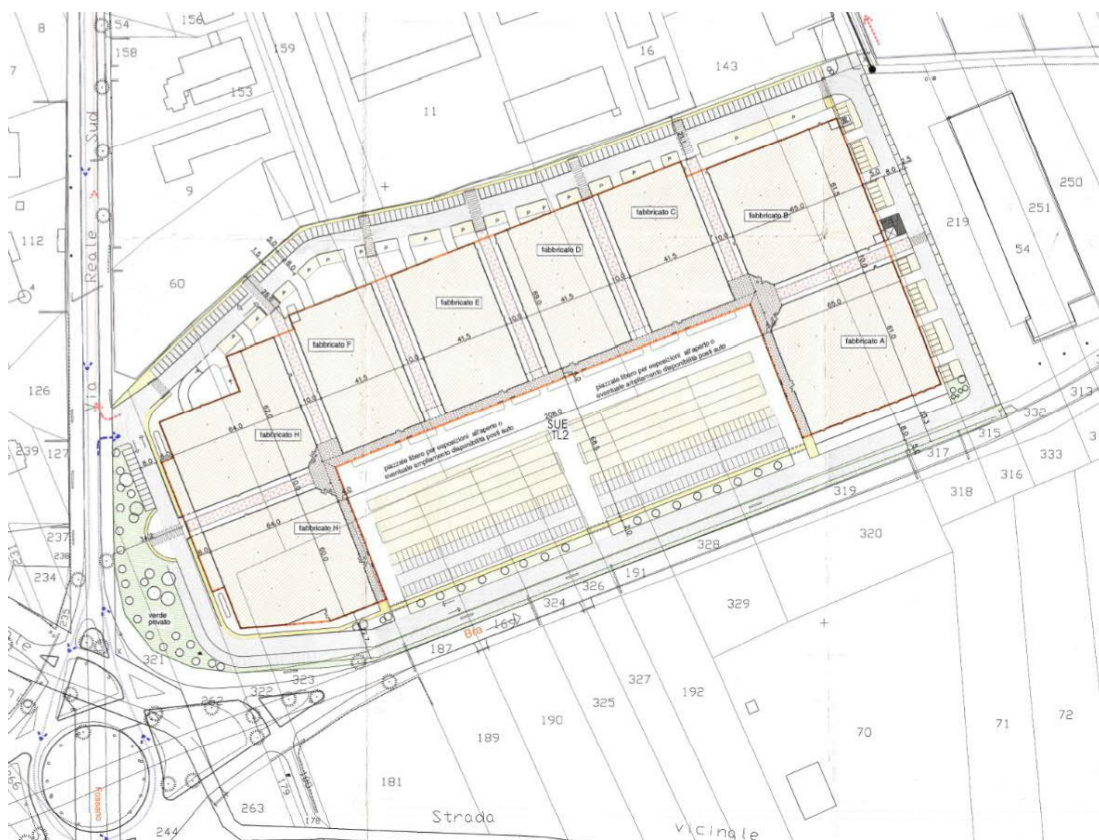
Planimetria di progetto del PEC approvato con D.C.C. n° 43/2003 per l'area D4-TL2
